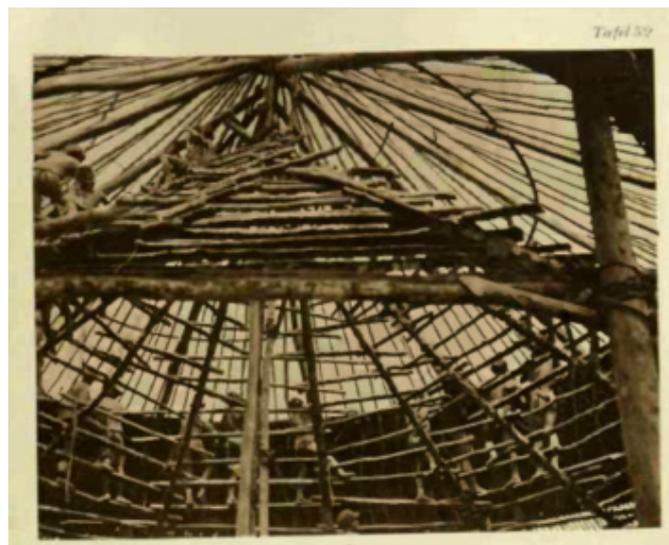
Estrutura de andaime utilizada na construção do ättä.
